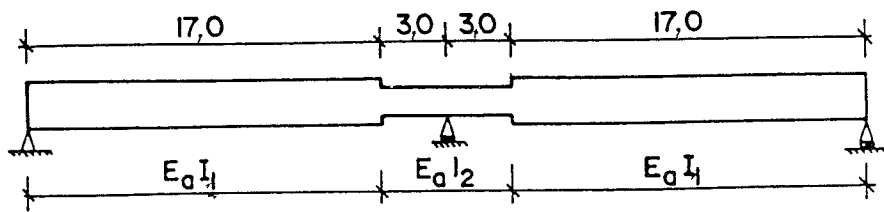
Distribución de rigideces a flexión, para tener en cuenta el efecto de la fisuración.
